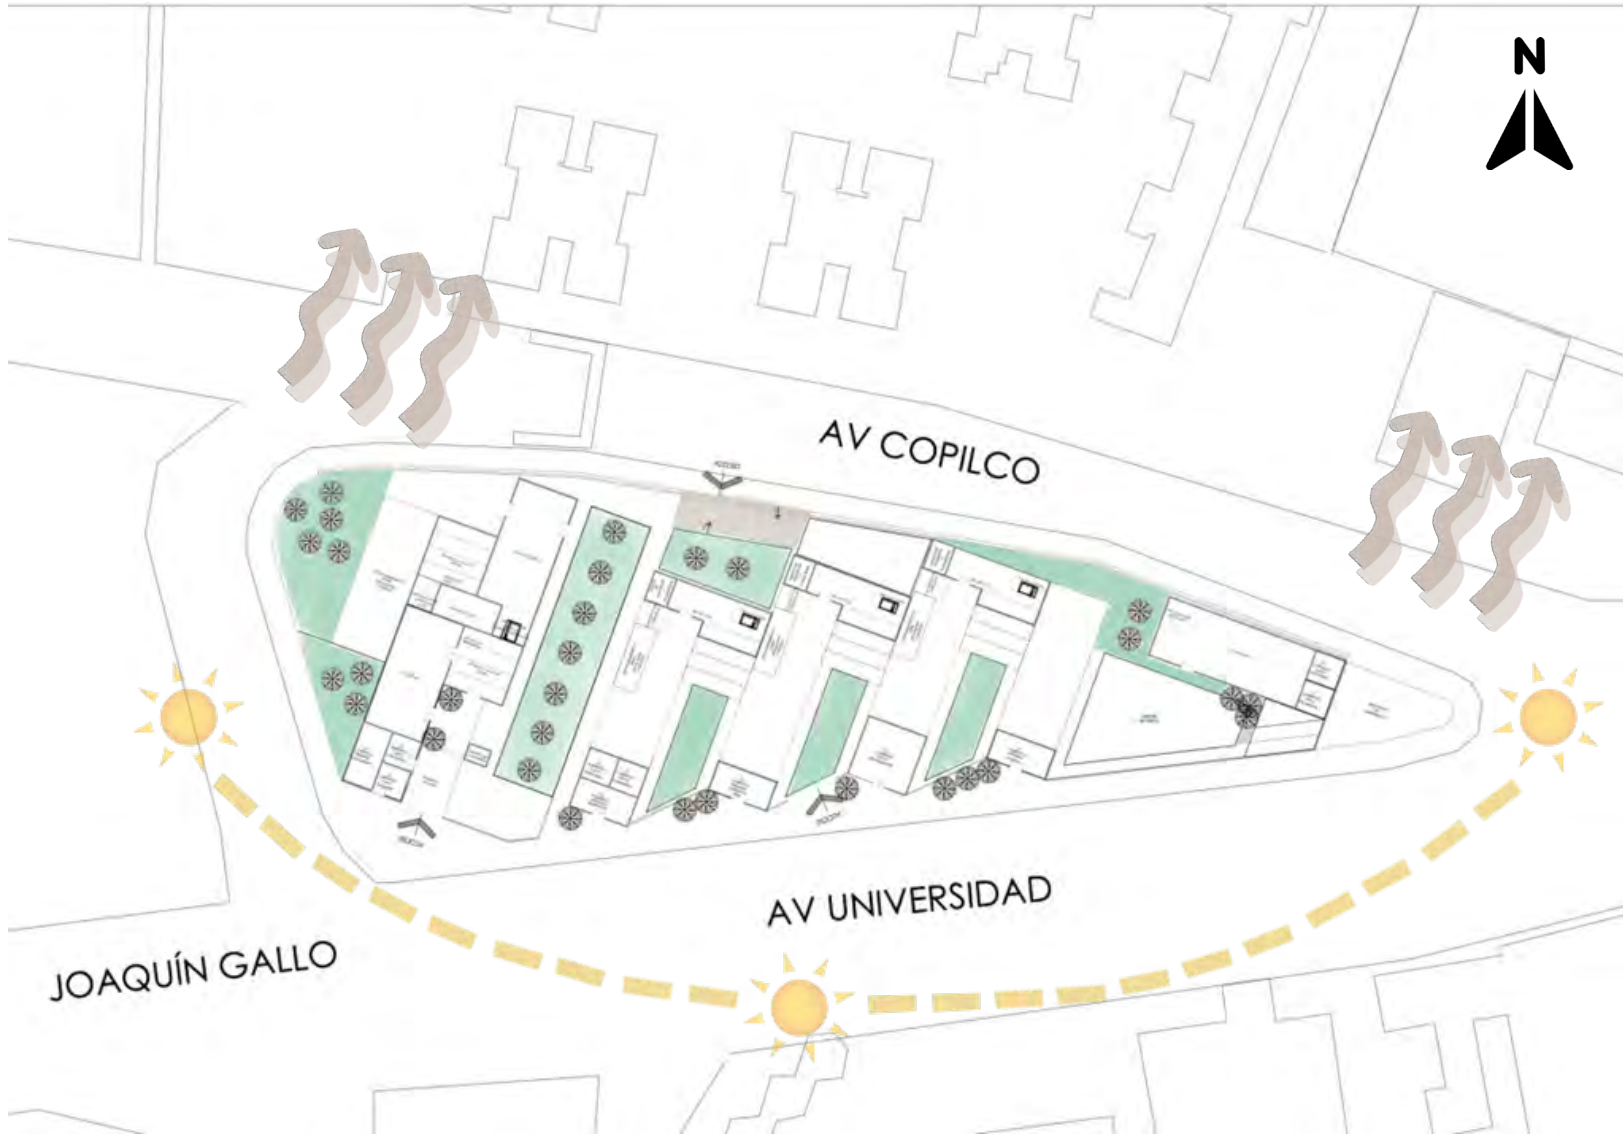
Planta Baja de conjunto. Creación Daniela Diaz 2022
